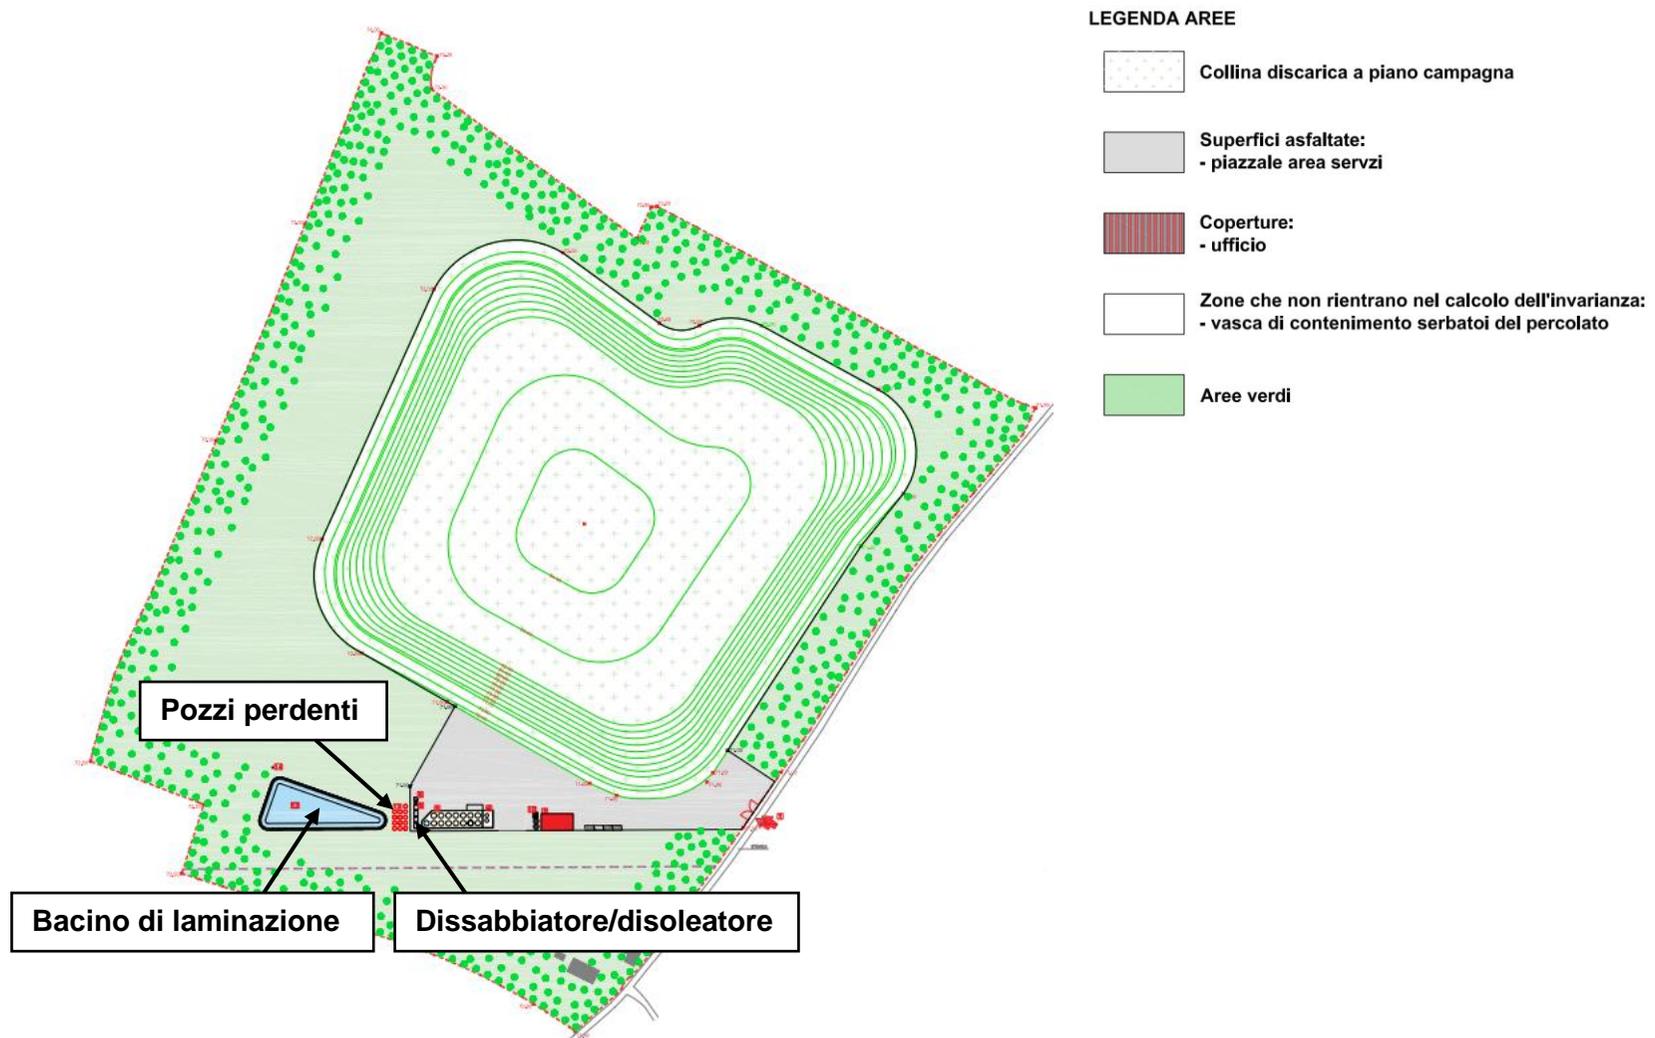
Planimetria con suddivisione delle aree di intervento a ripristino ambientale avvenuto
